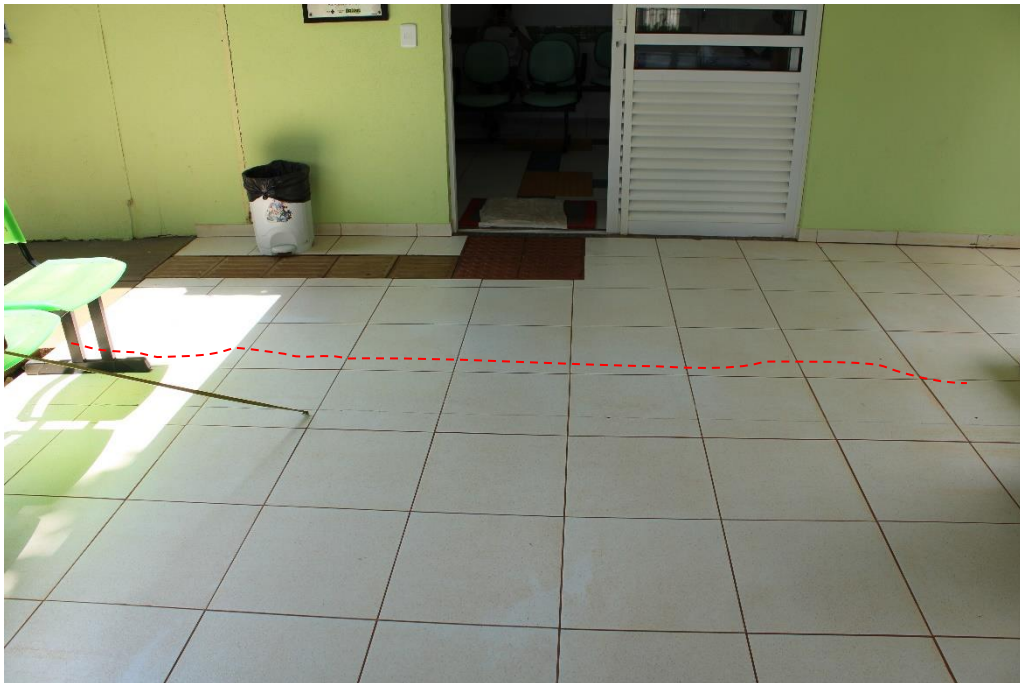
Vista da área coberta, supra qualificada, destacando fissura em revestimento cerâmico (piso).
